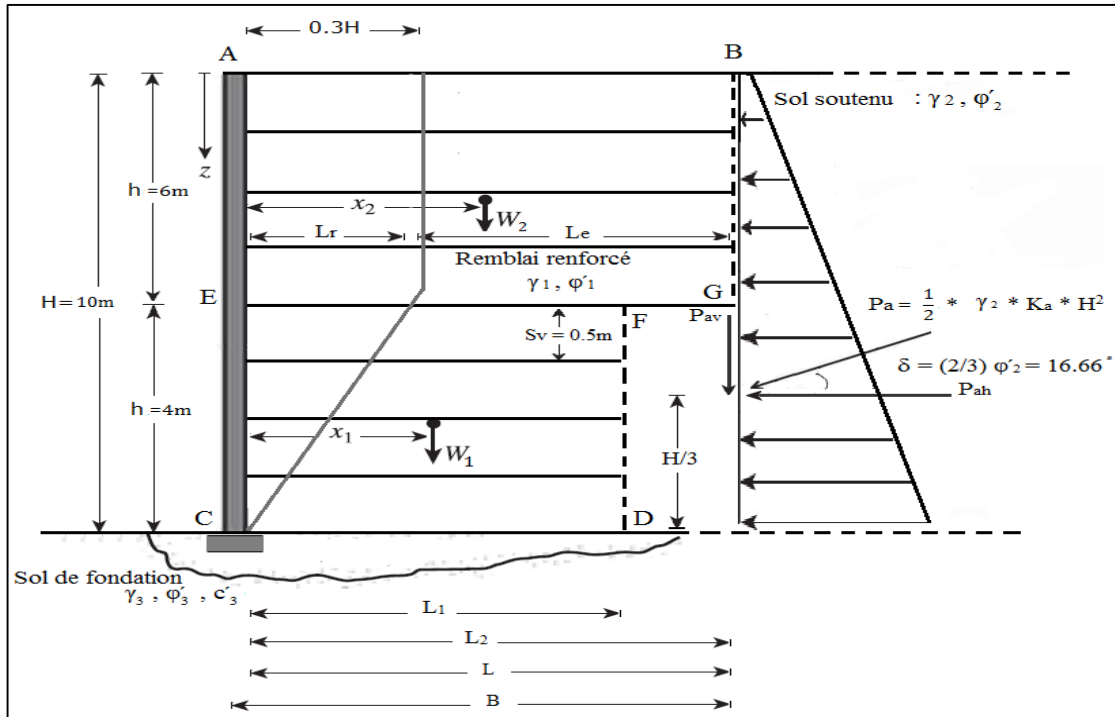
Schéma d'un mur de soutènement en Terre Armée renforcé par armatures métalliques
